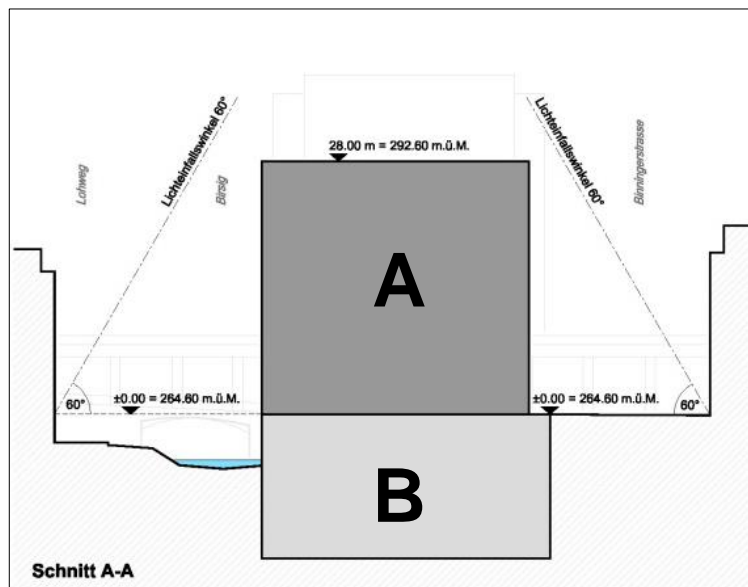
Neuer Bebauungsplan Plan Nr. 13'912: Schnitt (Kein Massstab, Plan genordet)
